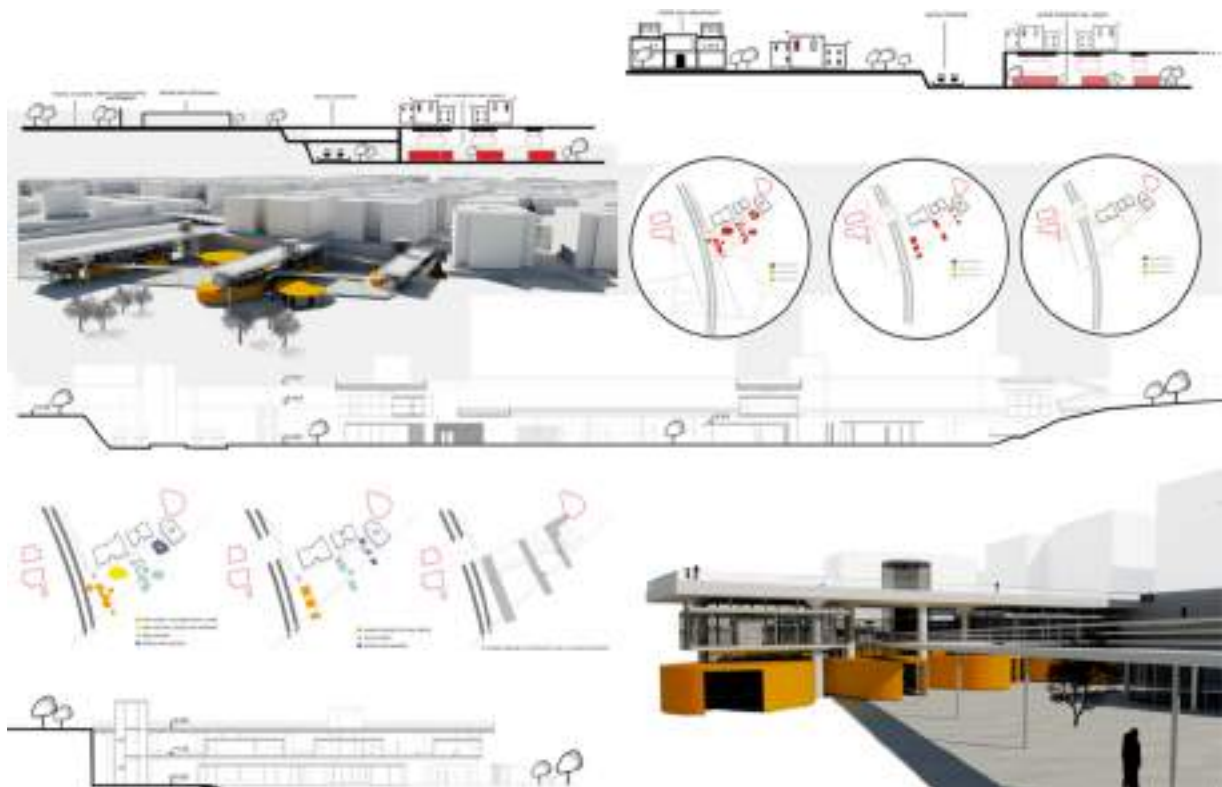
Vista prospettica e sezione sul passaggio sopraelevato
